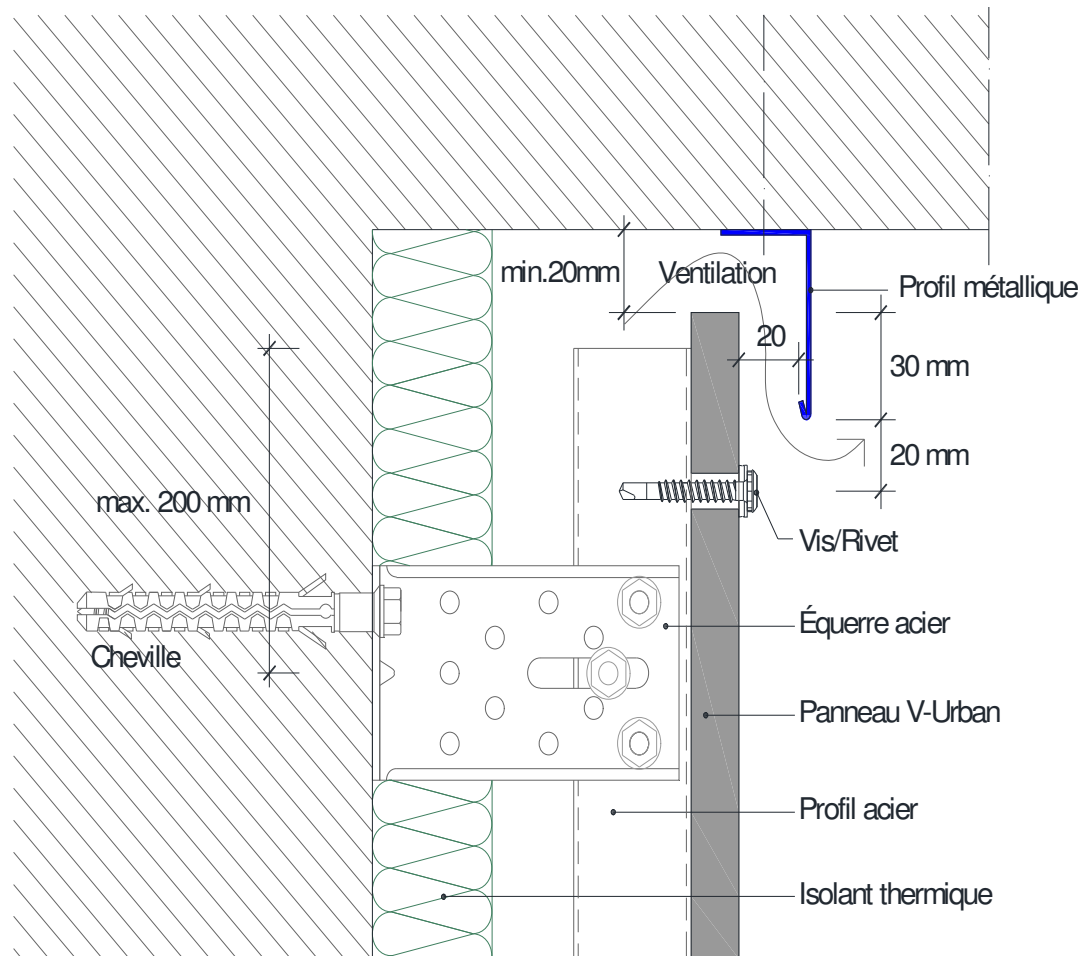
Joint vertical sur ossature acier (coupe horizontale)
